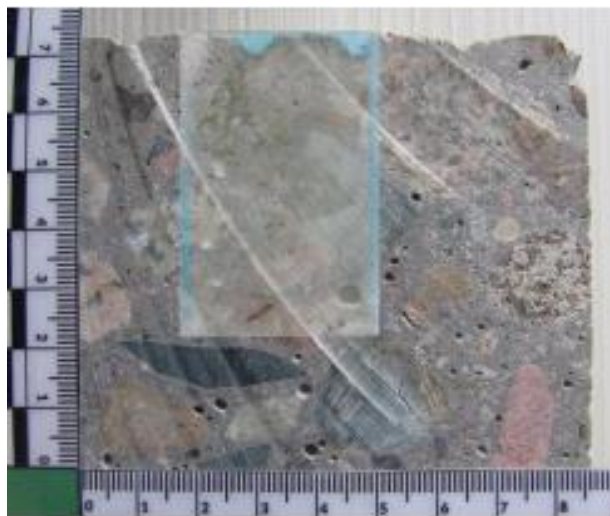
Bloque pulido y sección delgada del núcleo de concreto, muestra 14 (2023).
